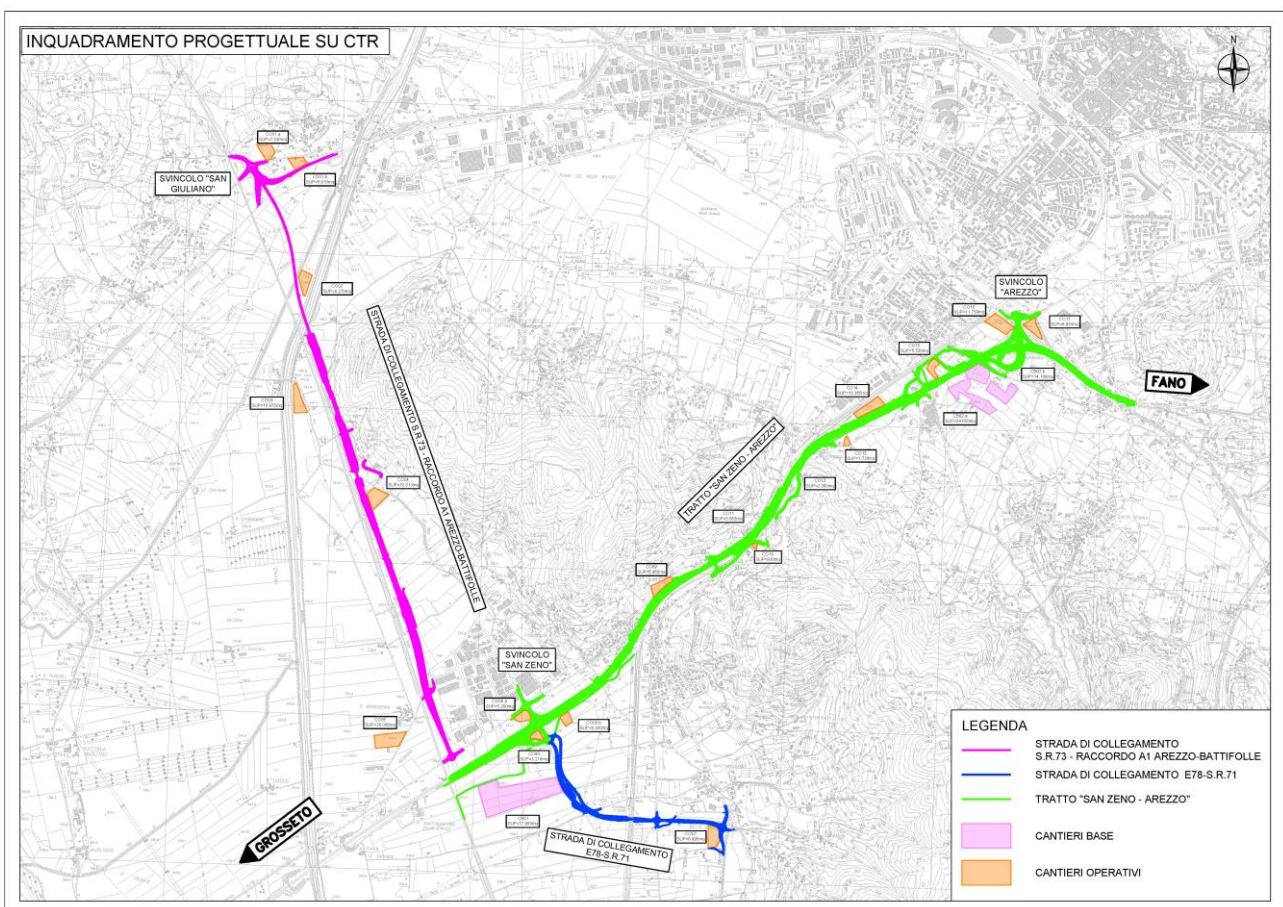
Inquadramento progettuale con suddivisione delle tratte di intervento
